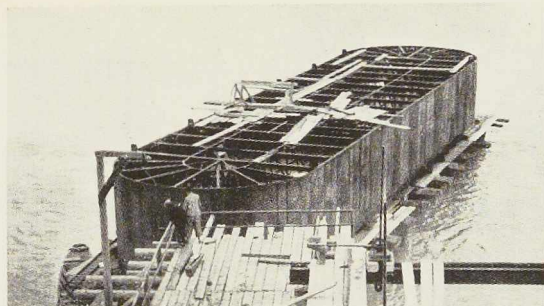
Caisson pour une pile du pont Horty Miklos à Budapest. Ce caisson de 15×7 mètres est entièrement soudé.
